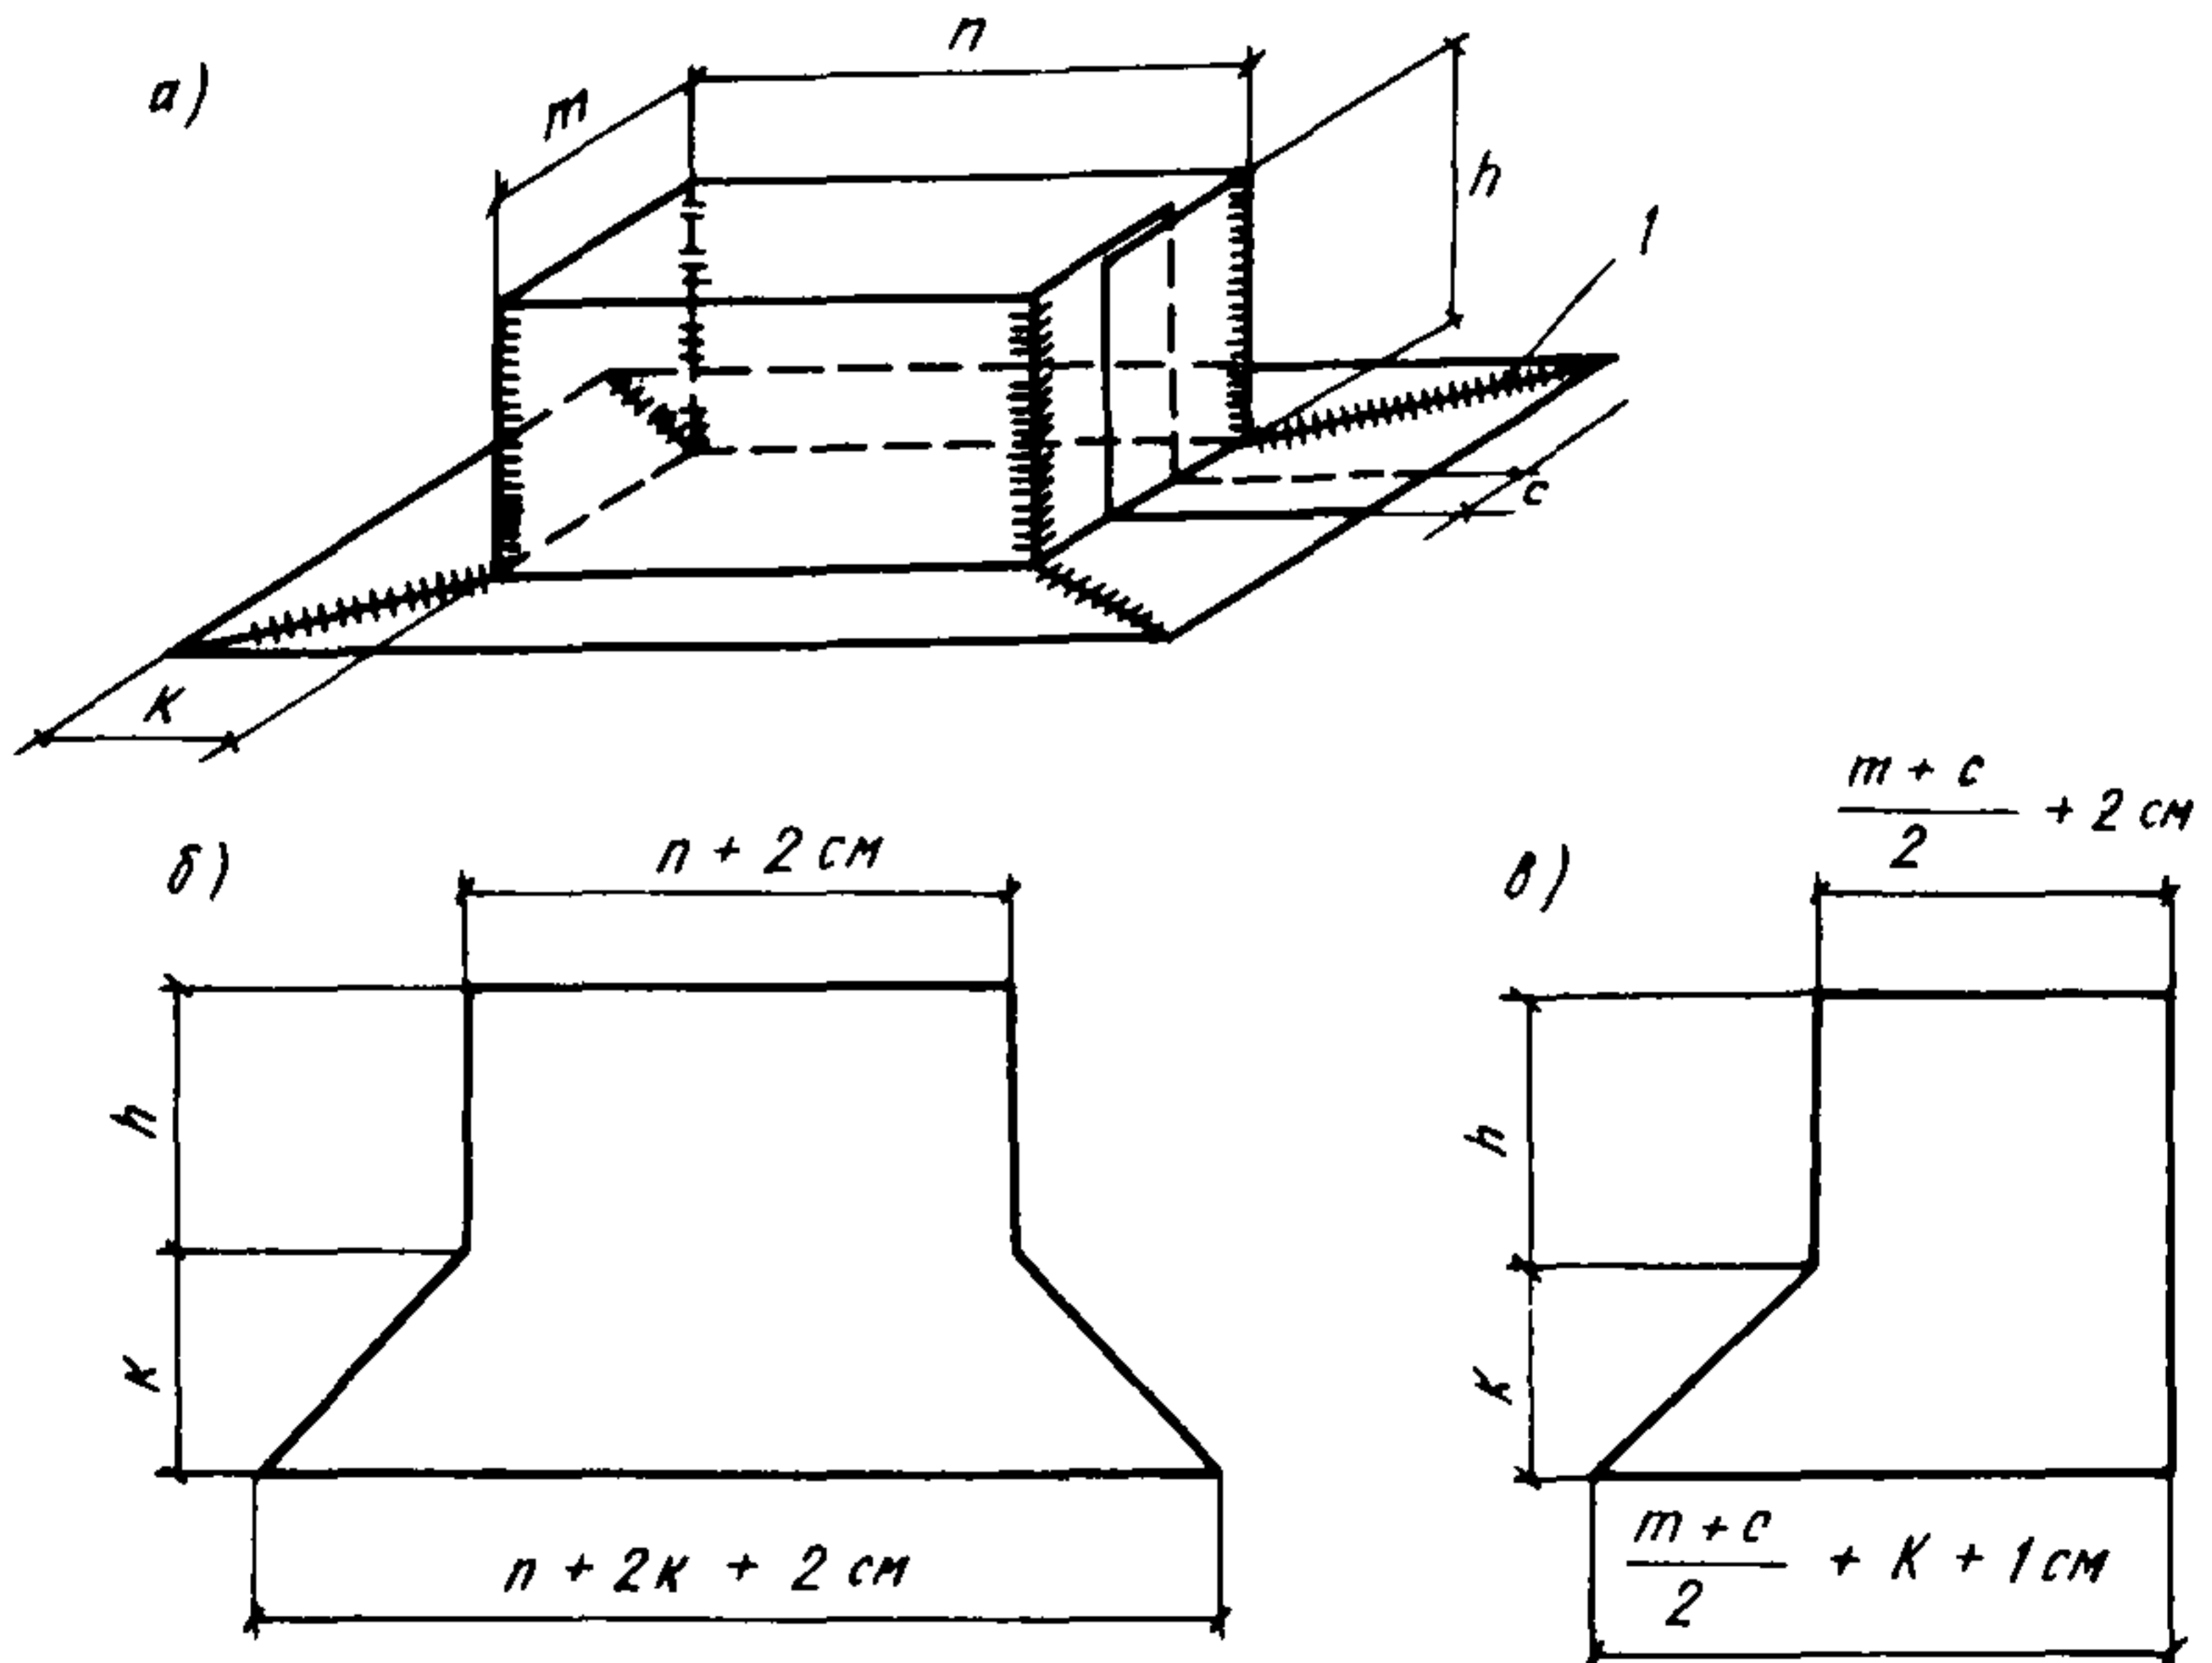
Схемы сварного "фартука" из активированной пленки для гидроизоляции примыкания пола к колонне или фундаменту
